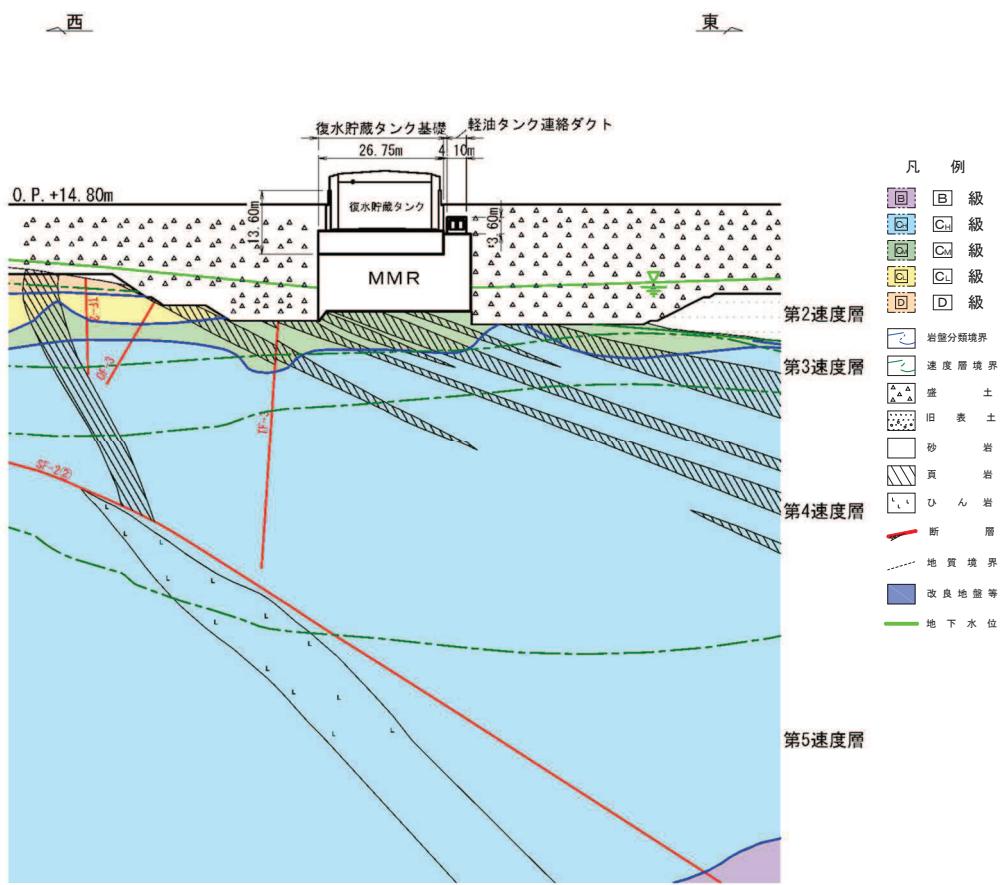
復水貯蔵タンク基礎地質断面図 (B-B)
